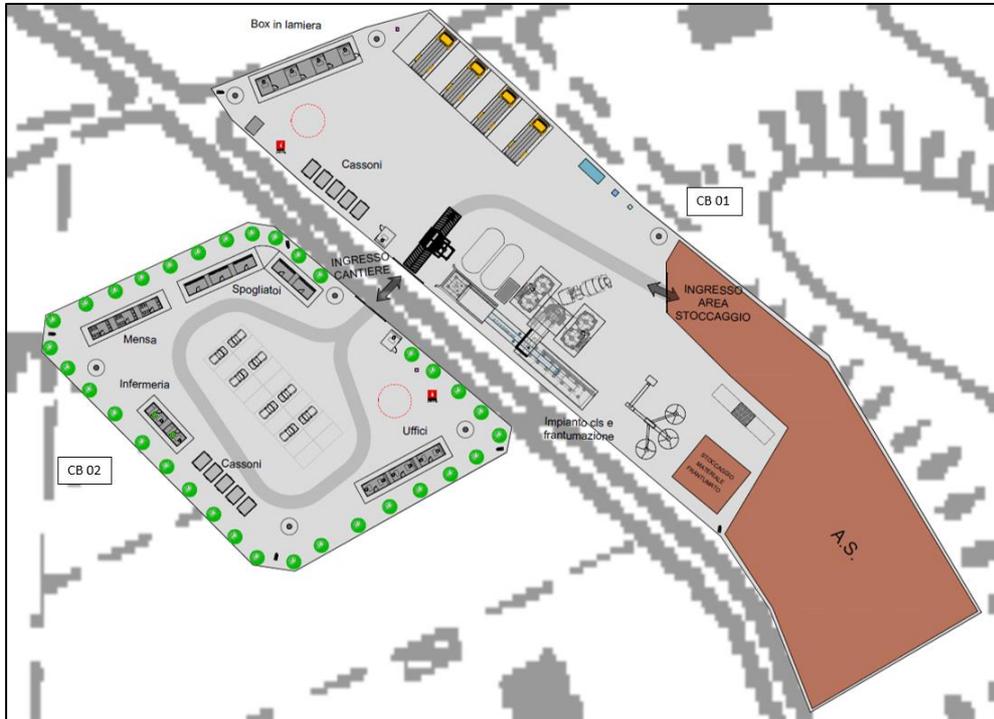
Layout cantieri base CB 01 e CB 02
